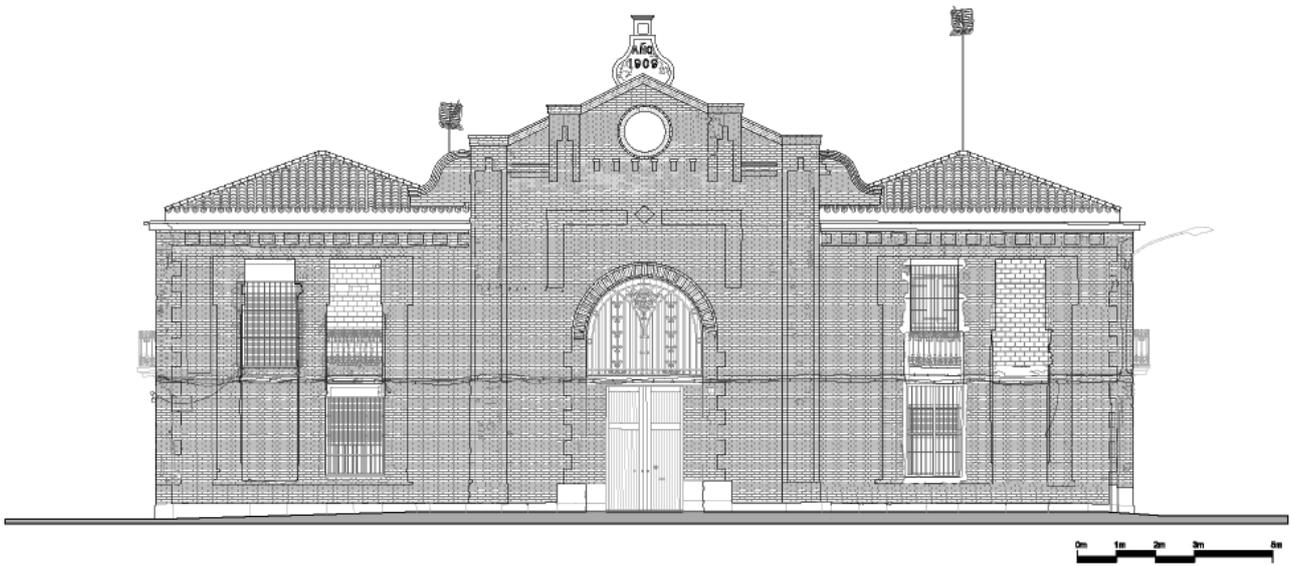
Dibujo de la fachada norte de la Lonja del Pescado
